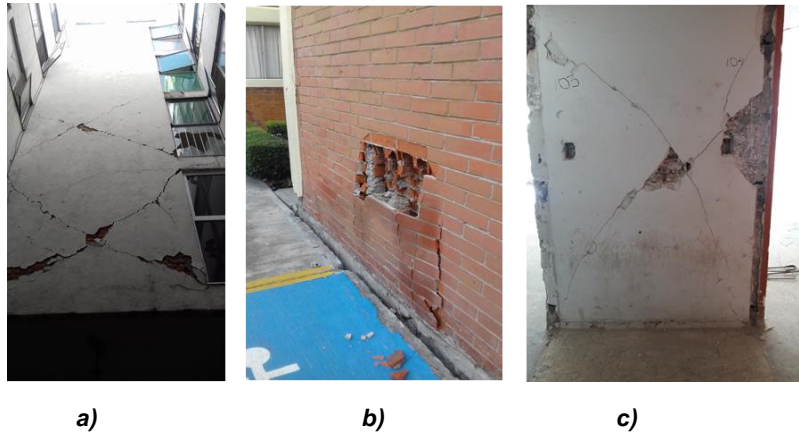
Evidencias de daños estructurales en muros de mampostería: a y c) daños por tensión diagonal, b) aplastamiento local. (Proyecto colaborativo ConTex, 2020).
